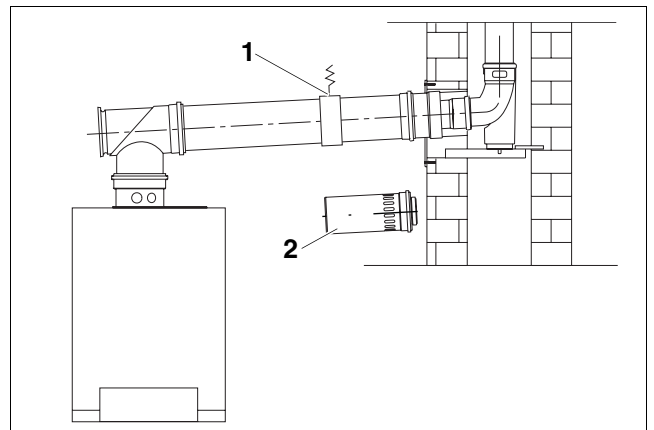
Heizkessel mit Schornsteinanschluss verbinden
